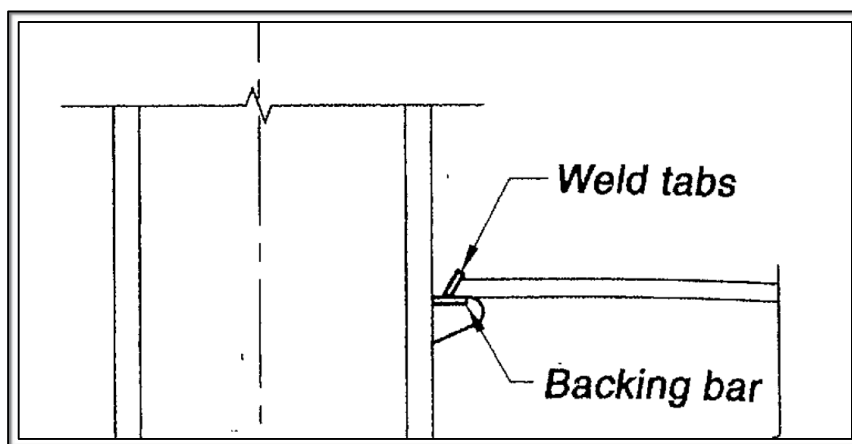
Elementos necesarios para realizar la soldadura. (Ramirez, 2016)
